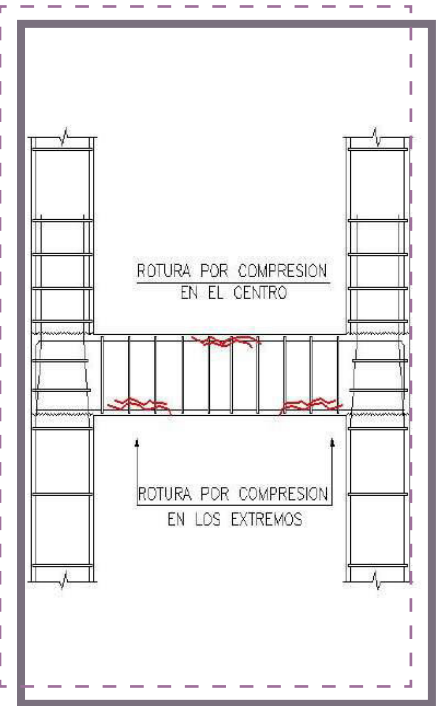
Esquema de fisuraciones por compresión en una viga de hormigón armado.
